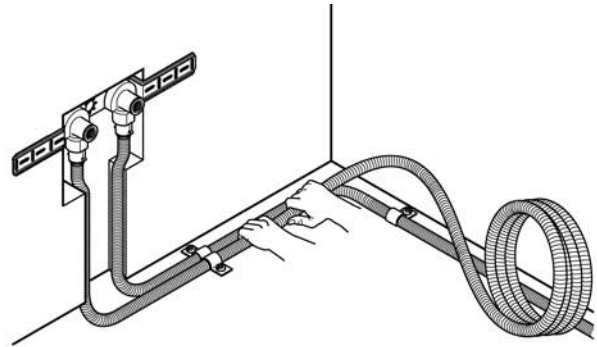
El tubo MeplaFlex con el tubo de protección se instala directamente del rollo
